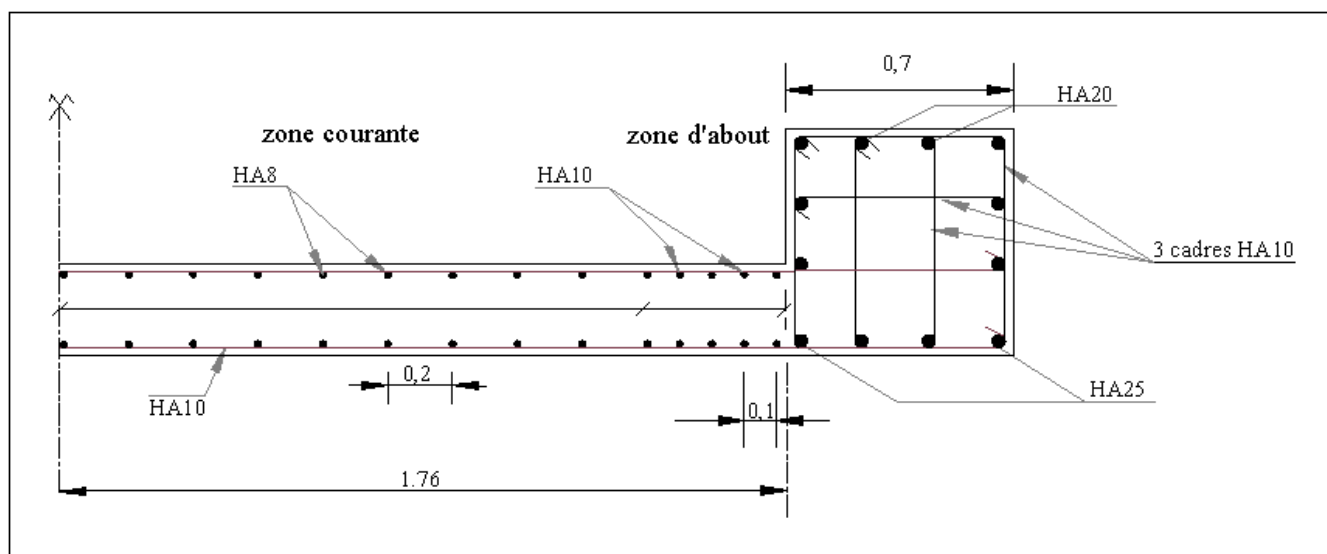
Croquis de ferrailage longitudinal du voile VI -Bloc A-
